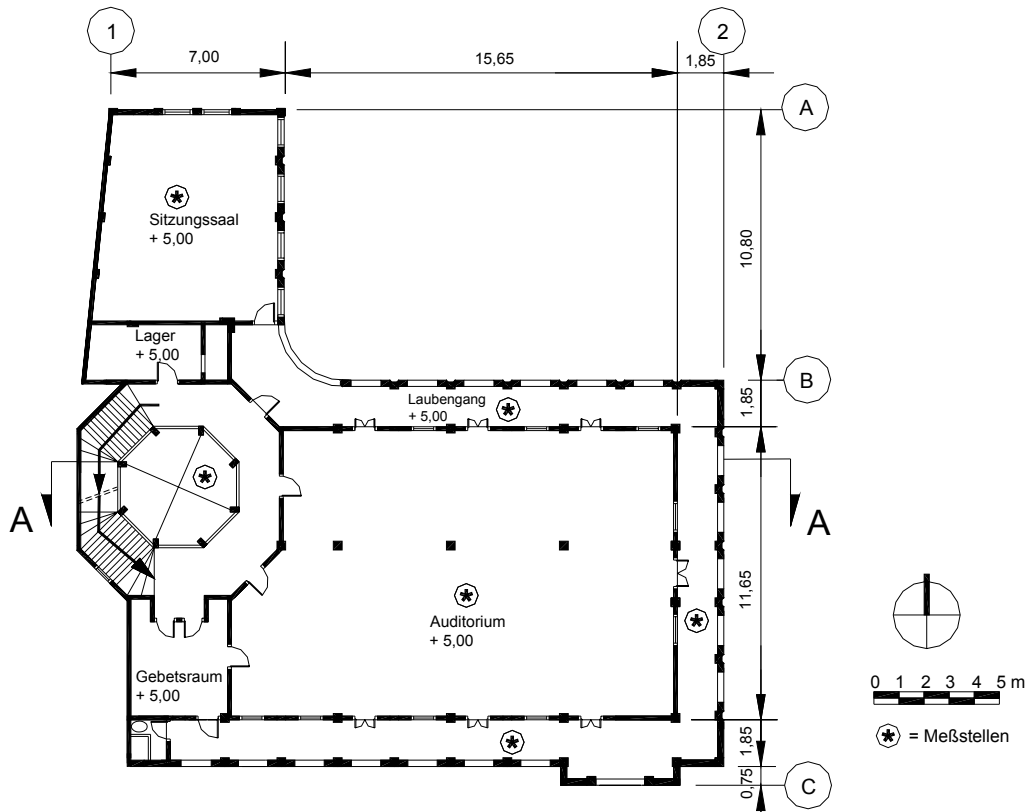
Grundriss 1. Obergeschoss von Gebäude C5
